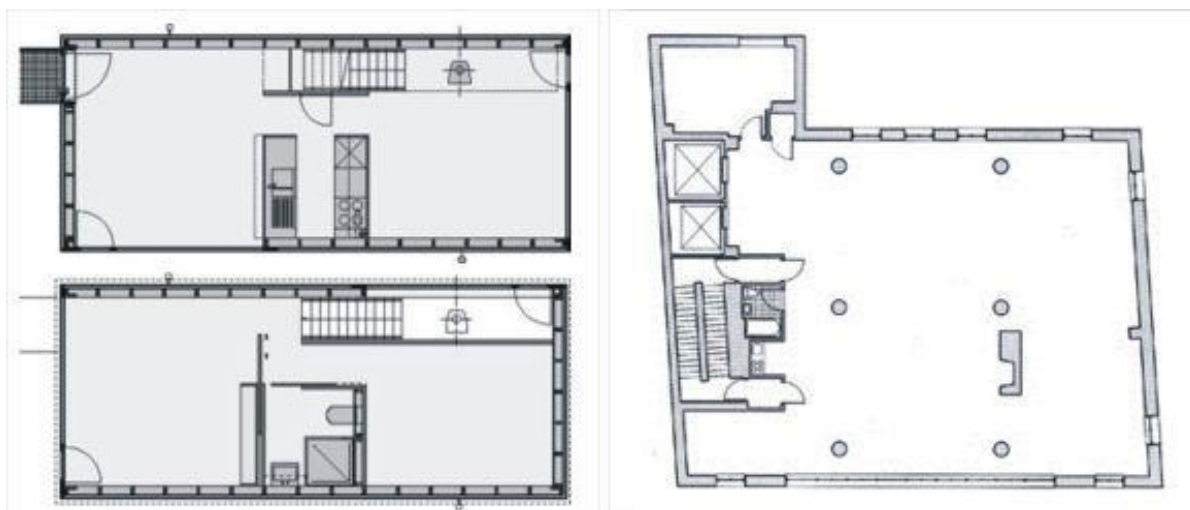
Proyecto Weberhouse Option (Suiza, 2000) y Proyecto 495 West Street (Estados Unidos, 2000). Vivienda de espacio libre con núcleo de instalaciones concentrado y de carácter permanente desde la etapa inicial. Fuente: imágenes tomadas de <http://www.afewthoughts.co.uk>
